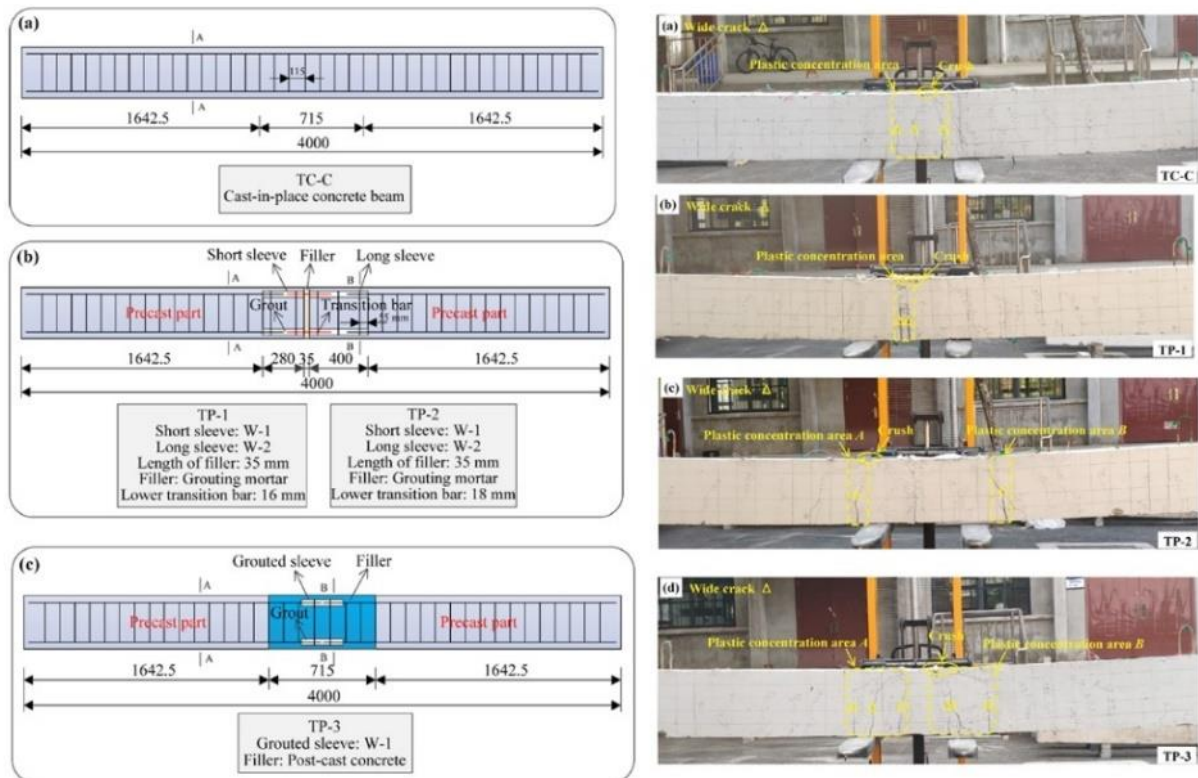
39 : Schéma de fissuration des poutres avec coupleurs d'armatures [56] [135] [136]
